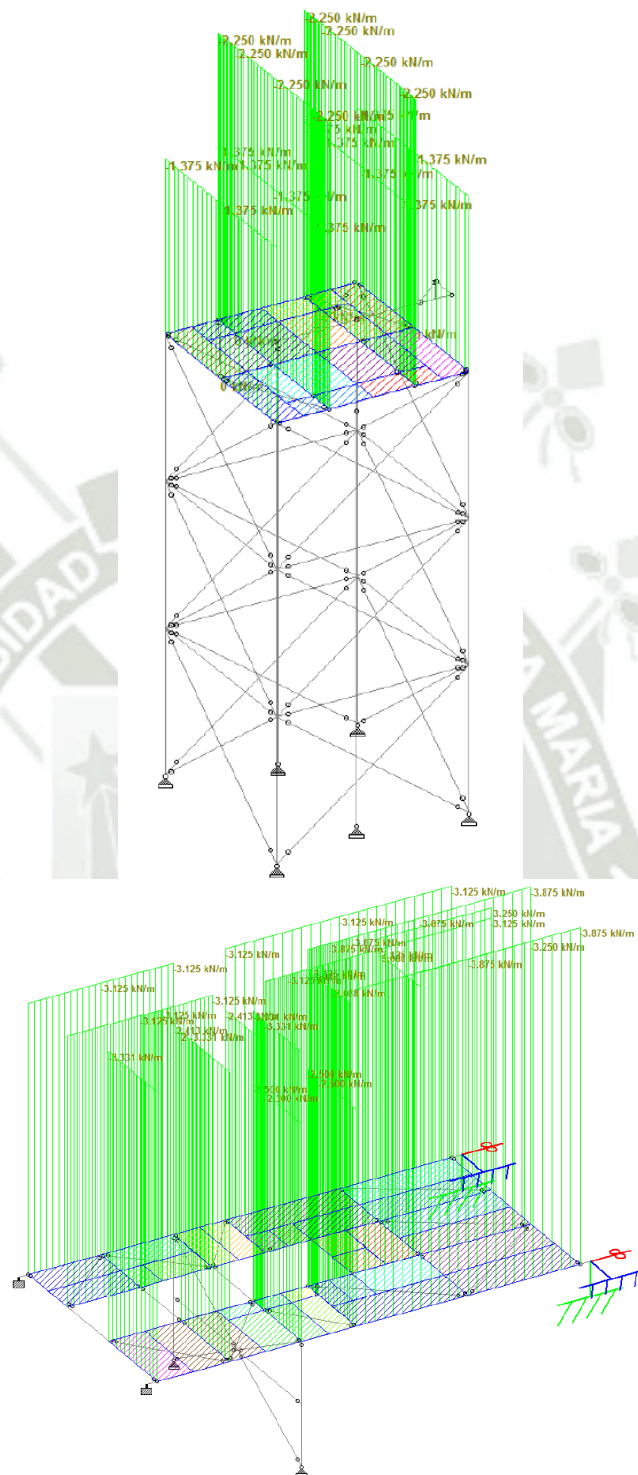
Carga Tipo 2 (LL) Aplicada a la estructura
